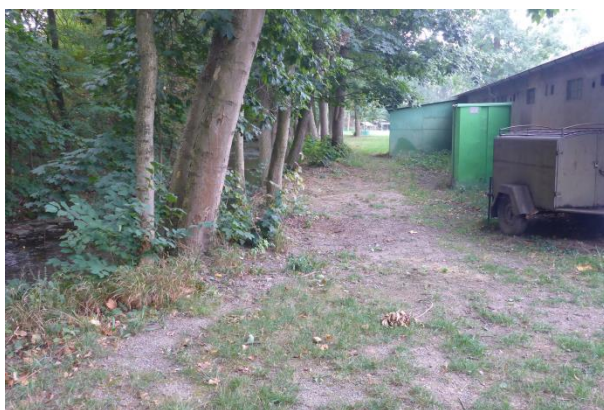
SO 04/SO 07 – Spojná šachta
